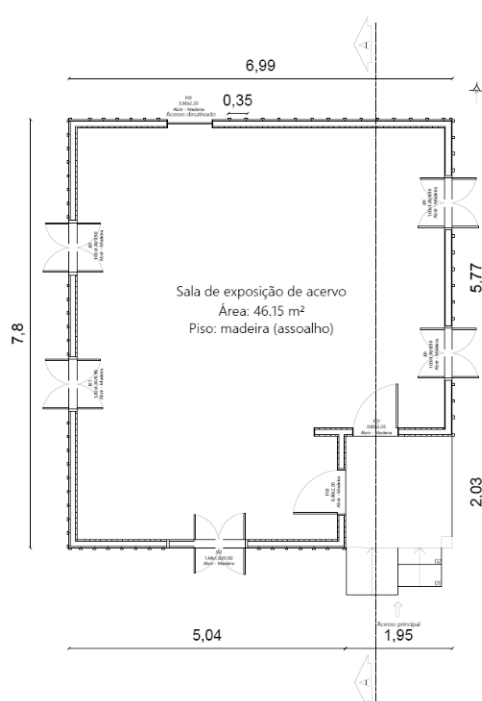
Planta baixa da Ficha 01, Moinho Richter.
